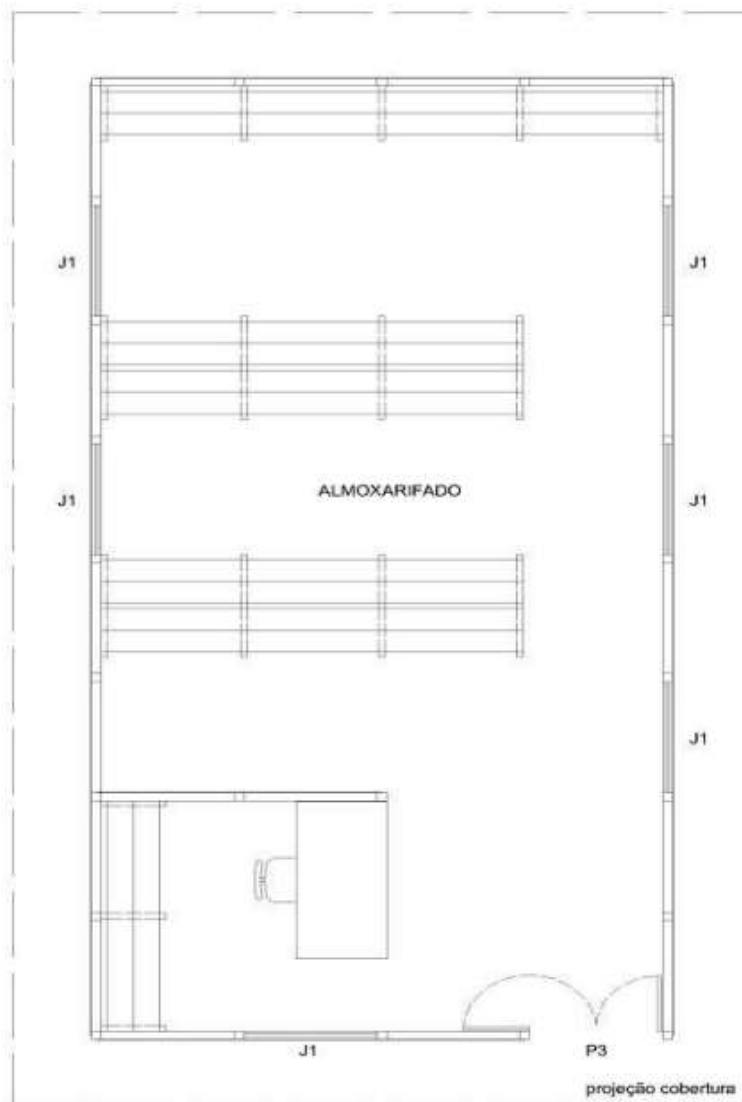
Layout* de referência de almoxarifado em canteiro de obra, em chapa compensada, utilizado para fins de especificação.
